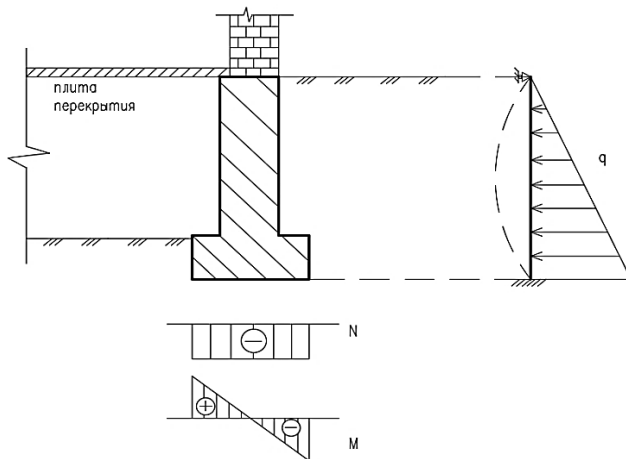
Нагрузки на стены подвалов малоэтажных зданий
